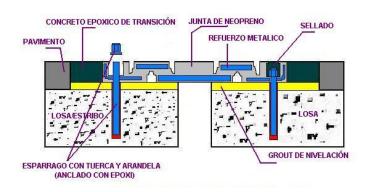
Junta constructiva cubierta con junta de Neopreno. Fuente: http://www.monografias.com/trabajos5/juntas/juntas.shtml
